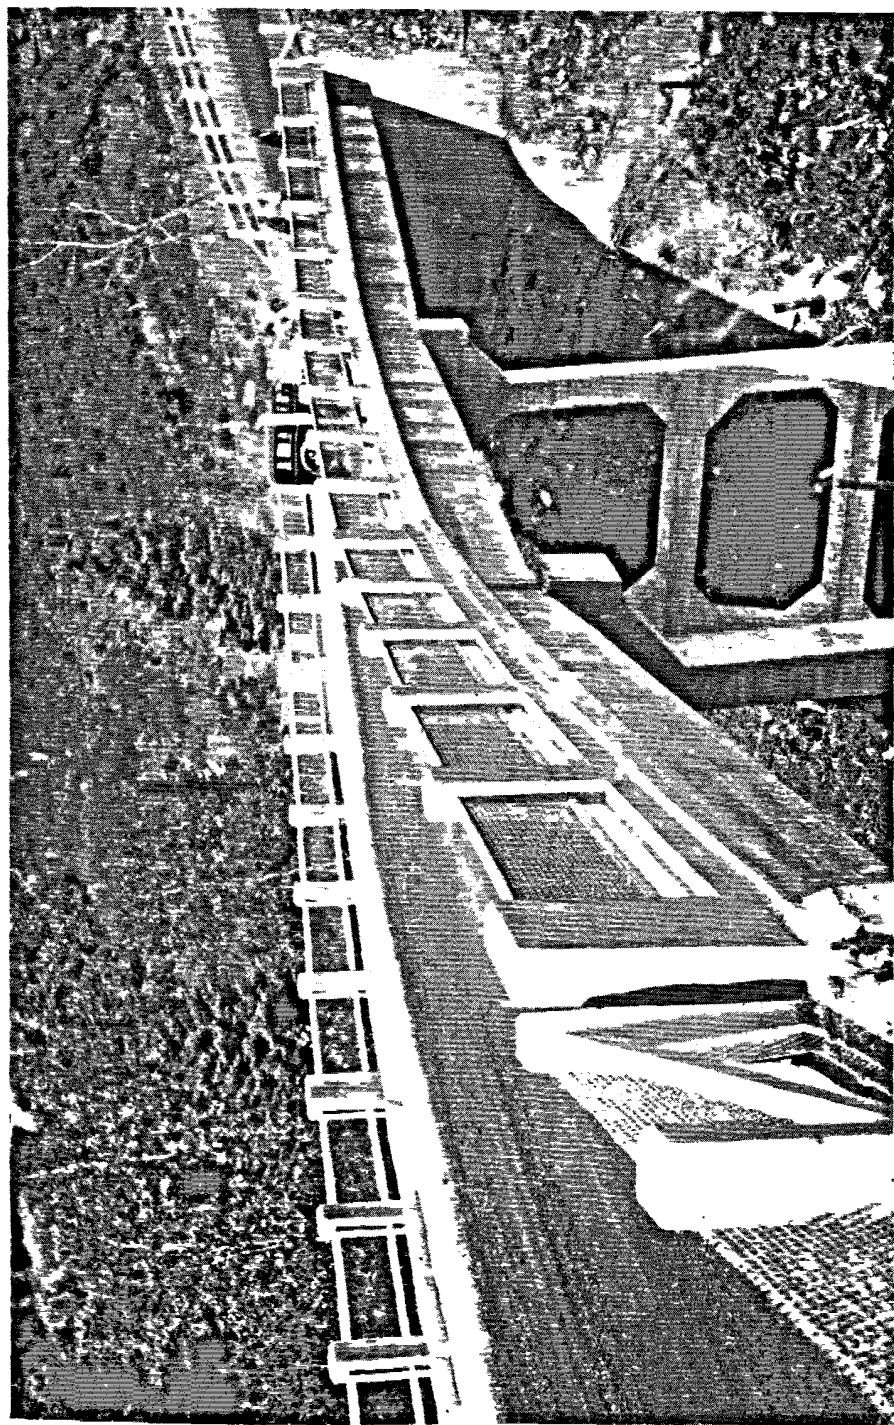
PONT SUR LE GROS RUISSEAU ENTRE ST-IRÉNÉE ET LA MALBAIE, COMTÉ CHARLEVOIX. (ROUTE BAIE ST-PAUL—LA MALBAIE VIA ST-IRÉNÉE).—Longueur 161 pieds, composé de trois travées, avec tablier en béton armé reposant sur deux culées en béton et deux chevalets en béton armé. Largeur de la voie charretière 20 pieds. Construit en 1931. Ce pont offre la particularité qu'il est en courbe.
